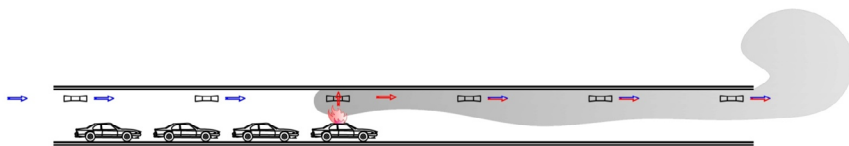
Продольная схема вентиляции автодорожного тоннеля с применением струйных вентиляторов. Продольный разрез
